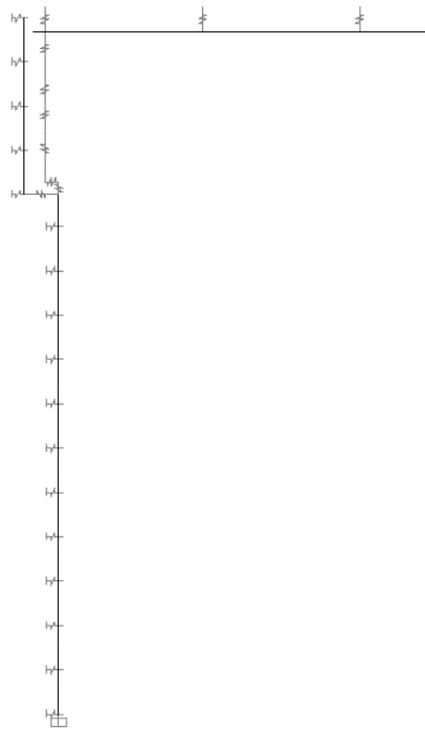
Dettaglio modellazione spalla con molle di Winkler
